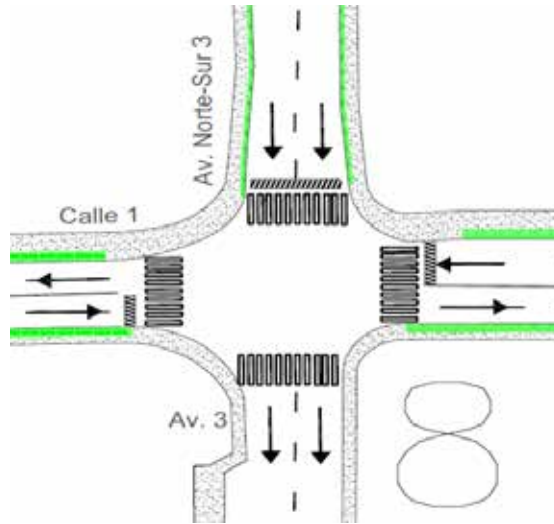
Intersección 8-Avenida Norte-Sur-Avenida 3-Calle 1
